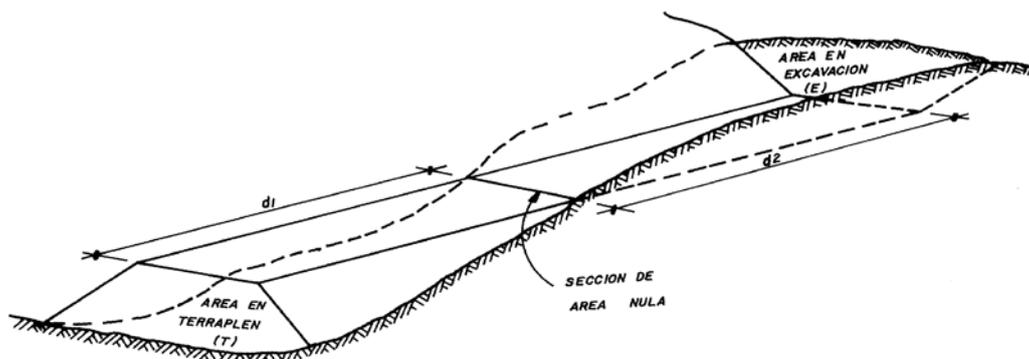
Secciones transversales continuas en terraplén y en excavación
